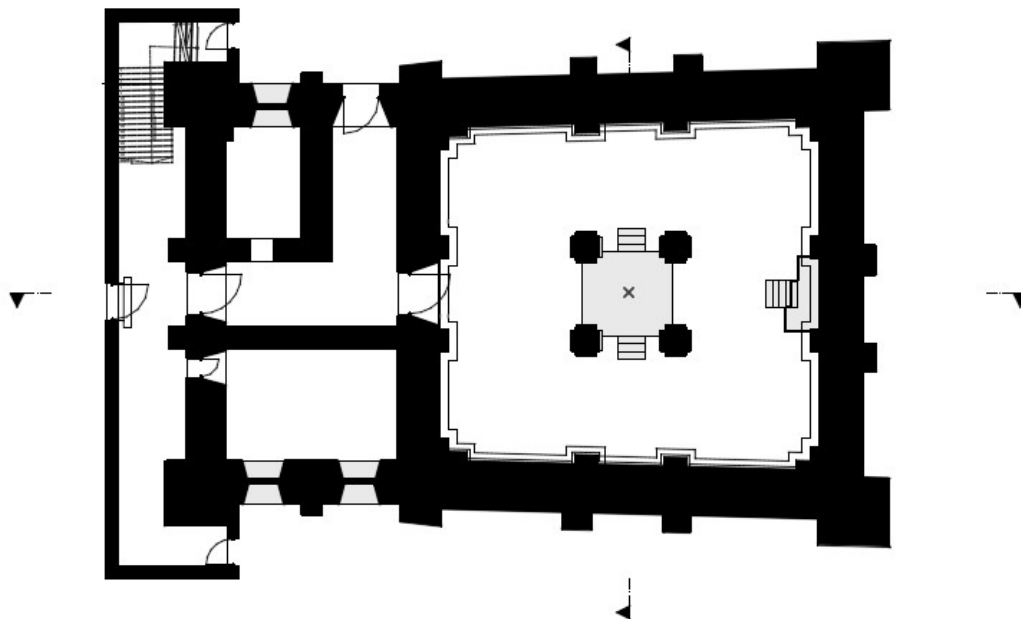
Grundriss_EG_Rekonstruktion
